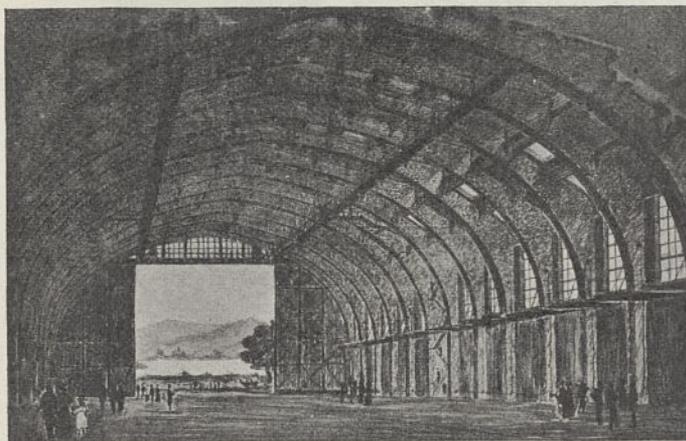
Zweischiffige Bauhalle in Eisenbeton.
